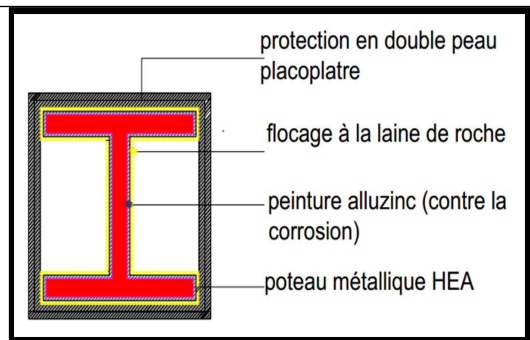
detail des poteau metalique source : [www.detailconstructif.cype.com](http://www.detailconstructif.cype.com)
